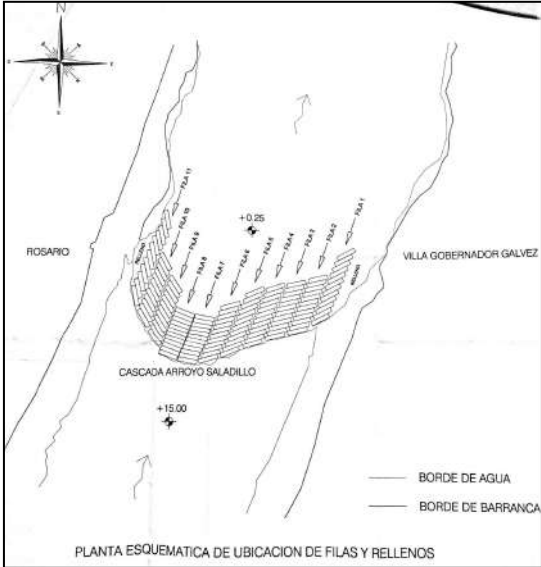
Planimetría del refuerzo provisional GeoBags. Obra: Refuerzo de emergencia a pie de cascada del Arroyo Saladillo - Ciudades de Rosario y Villa Gobernador Gálvez - Departamento Rosario - Provincia de Santa Fe. Año 2017.
